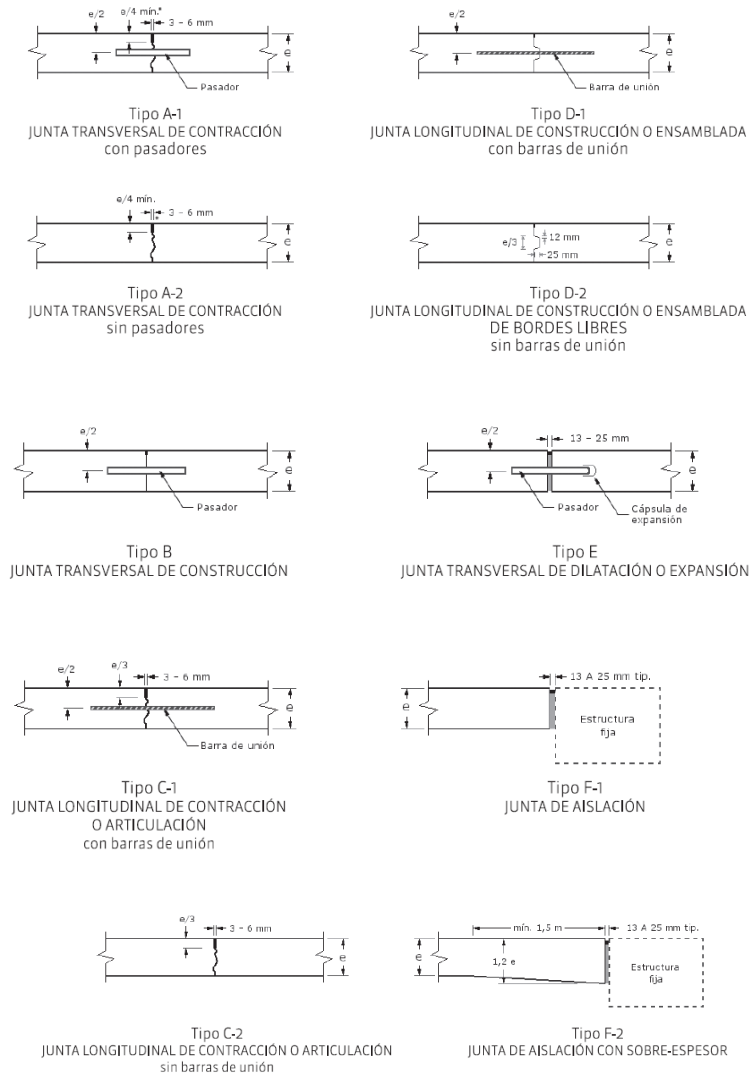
Clasificación y tipos de juntas (Fuente: Manual de diseño y construcción de pavimentos de hormigón)
